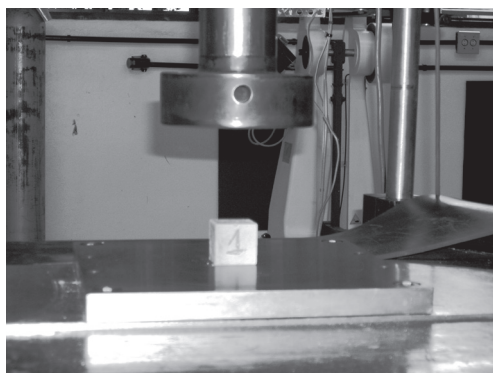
Cubo de argamassa de 4 cm para ensaio de compressão.
